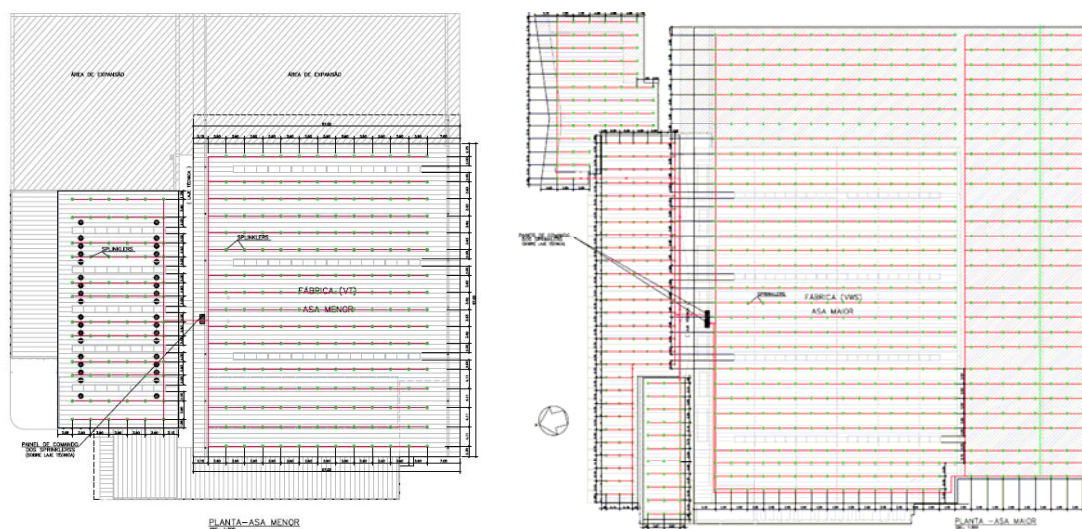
Projeto da distribuição de sprinklers na planta da fábrica.
